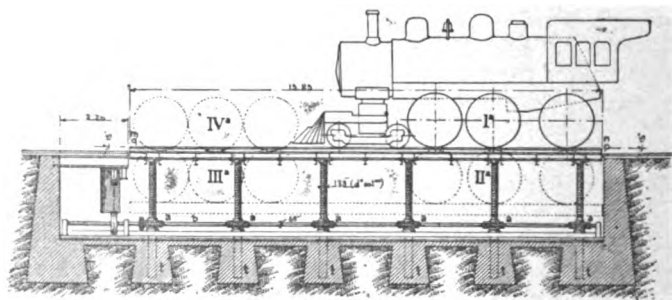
Drop-table Sezione longitudinale e pianta.
